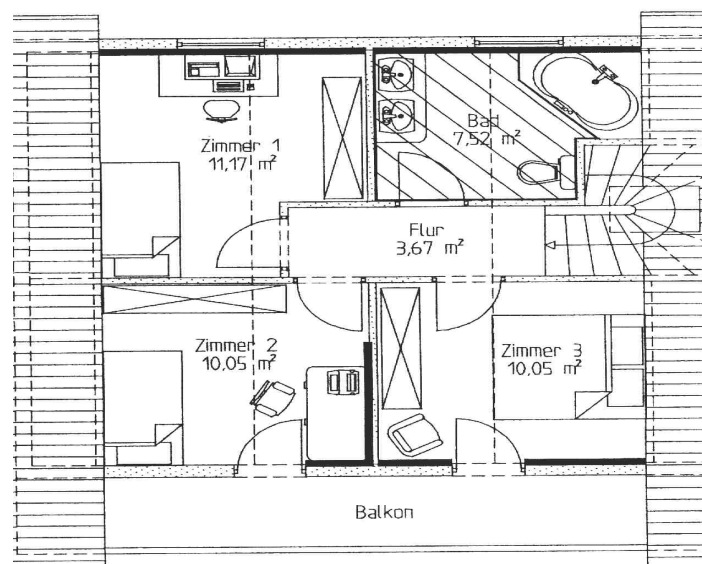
Beispiel zur Aufteilung von Wandheizflächen (schwarz) in einem Dachgeschoss
